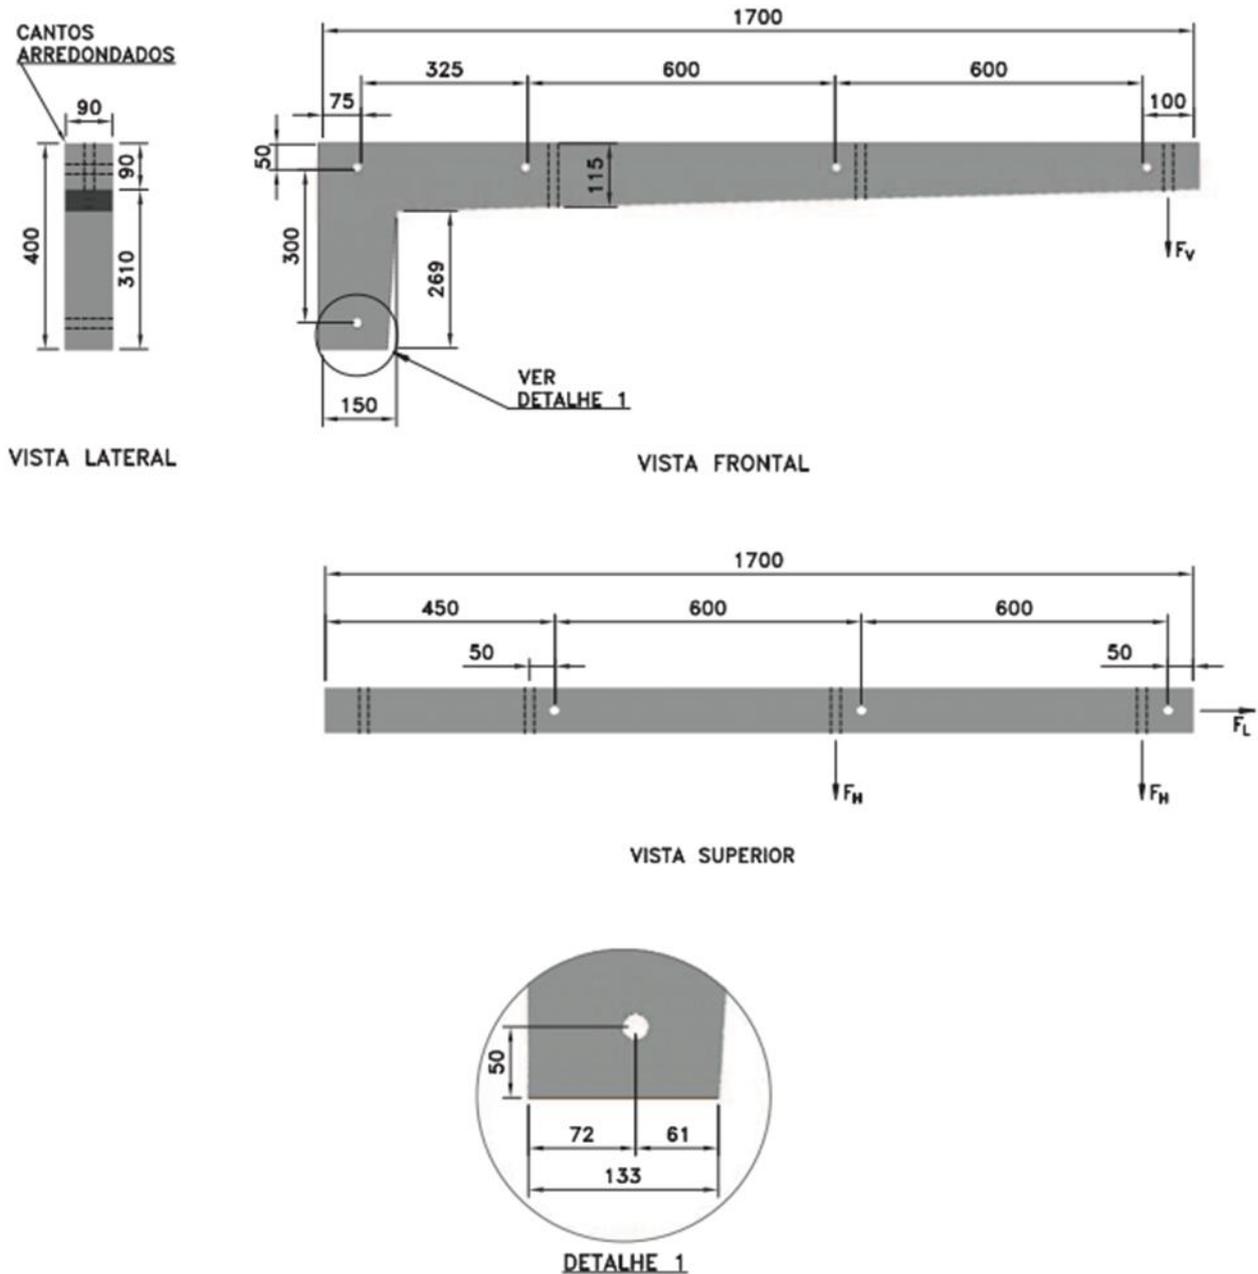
Cruzeta de concreto armado - tipo "L" – 1700mm
